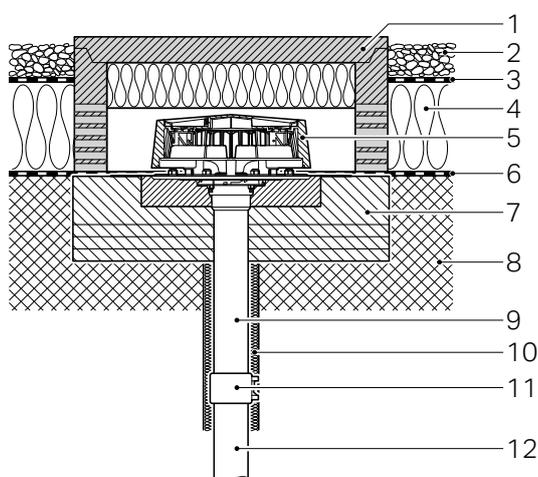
Dachaufbau Umkehr- / Nassdach, bekiest – Geberit Pluvia Dachwassereinlauf mit Einsatzring mit Folie
